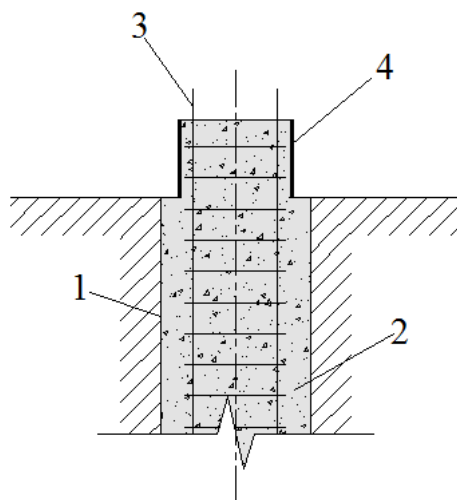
Конструктивная схема устройства оголовка НРСн в несъемной опалубке: 1- раскатанная скважина; 2- свежееуложенная бетонная смесь; 3- арматурный каркас; 4- опалубка.
